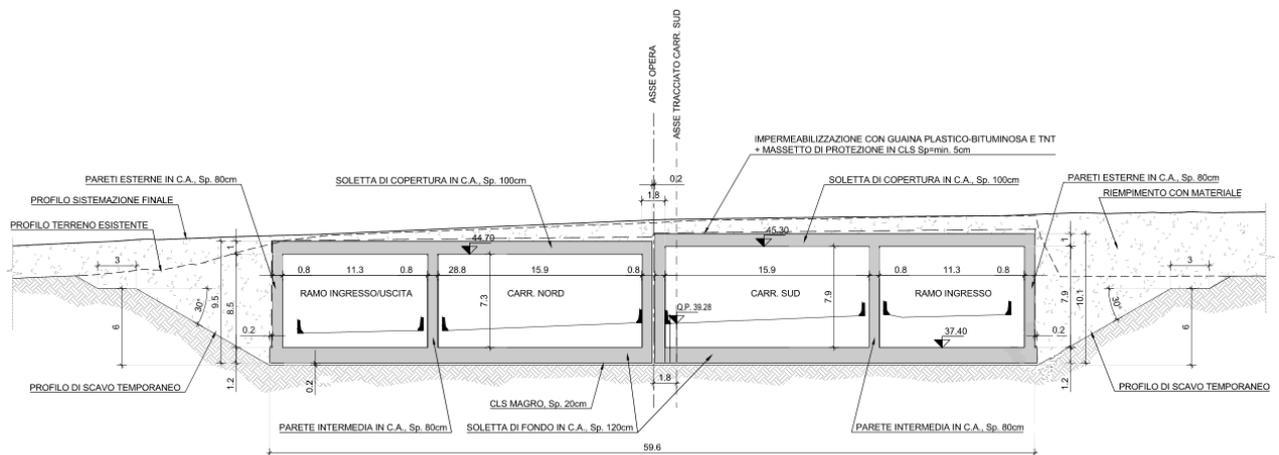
Galleria artificiale GA-02: Sezione trasversale
